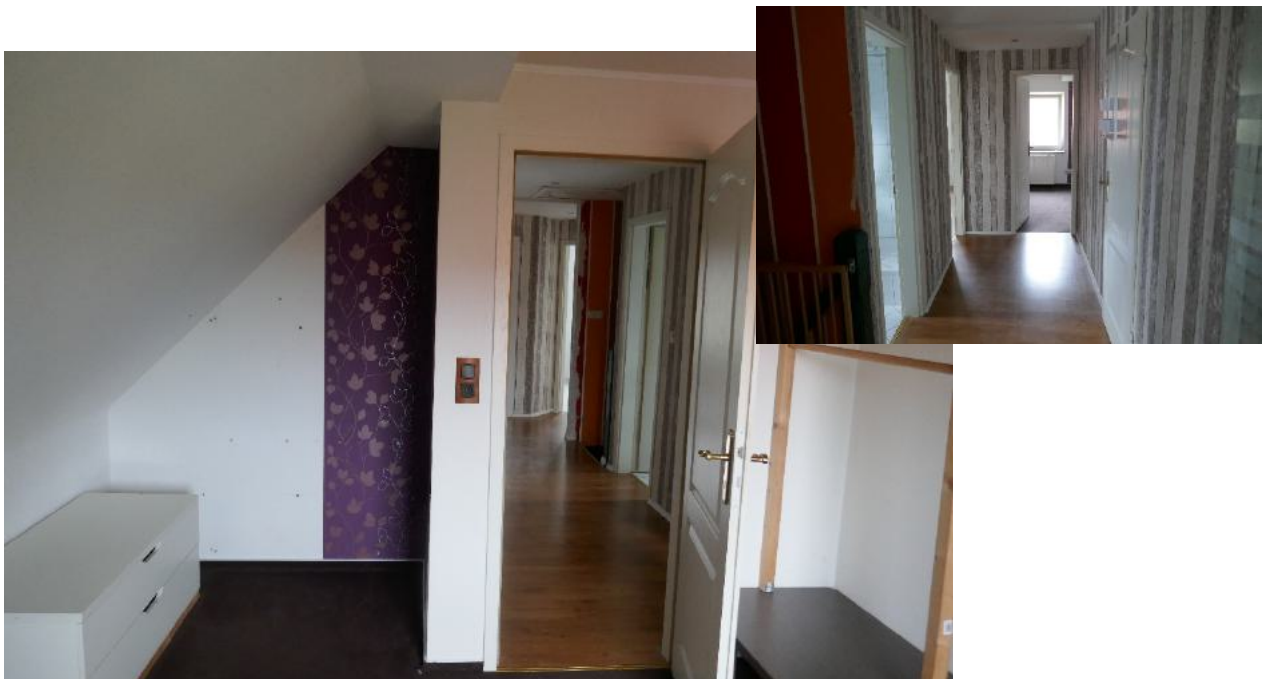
, Dachgeschoss (DG), Blick in den Flur und Flur (kleines Foto)
